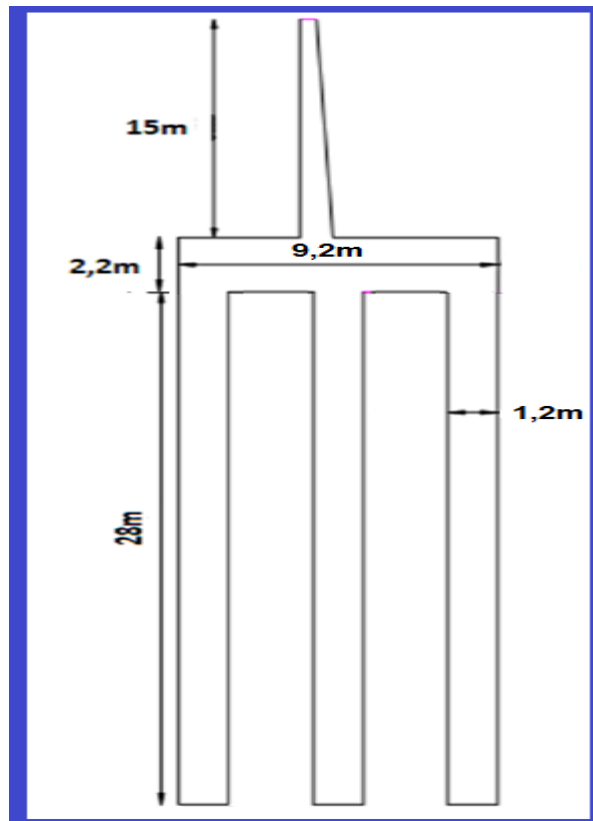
Dimensions du mur en B.A sur pieux.
